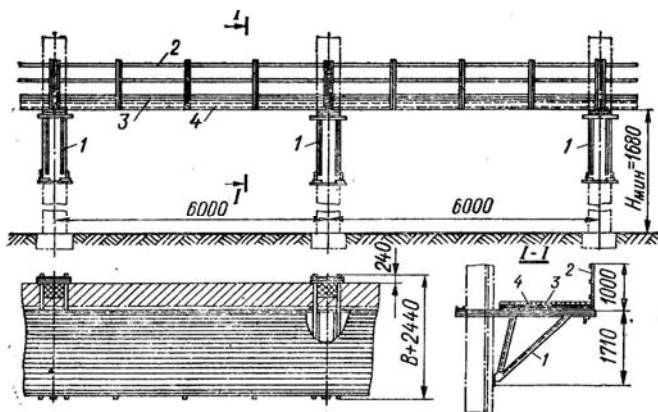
Панельные подмости на треугольных шарнирных опорах:
